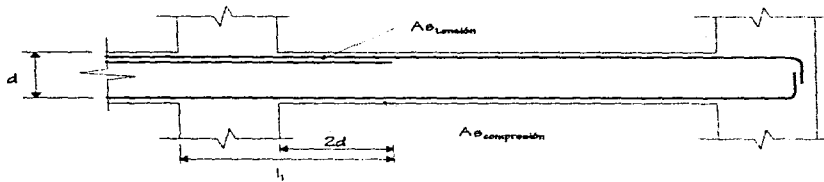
Requisitos de refuerzo longitudinal en vigas
